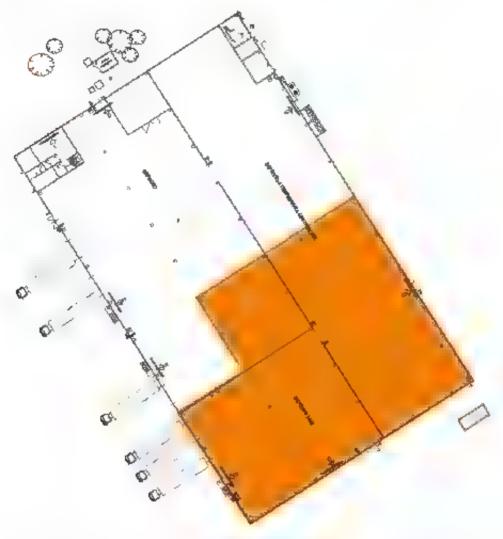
14 Planimétrie du bâtiment industriel soumis à l'intervention avec la technologie Uretek Floor Lift®
